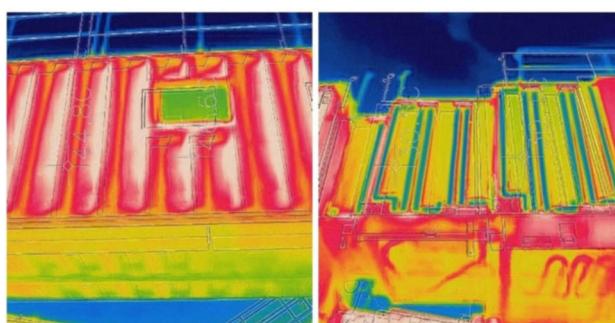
PBBへの施工前後の表面温度の比較(左:施工前、右:施工後)
